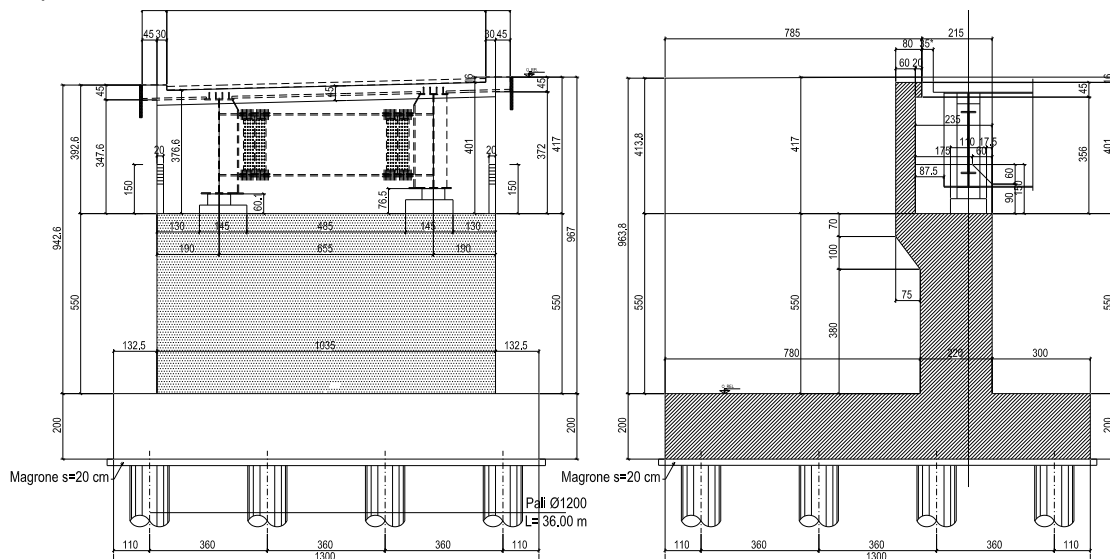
Vista frontale e sezione longitudinale spalle SP1
